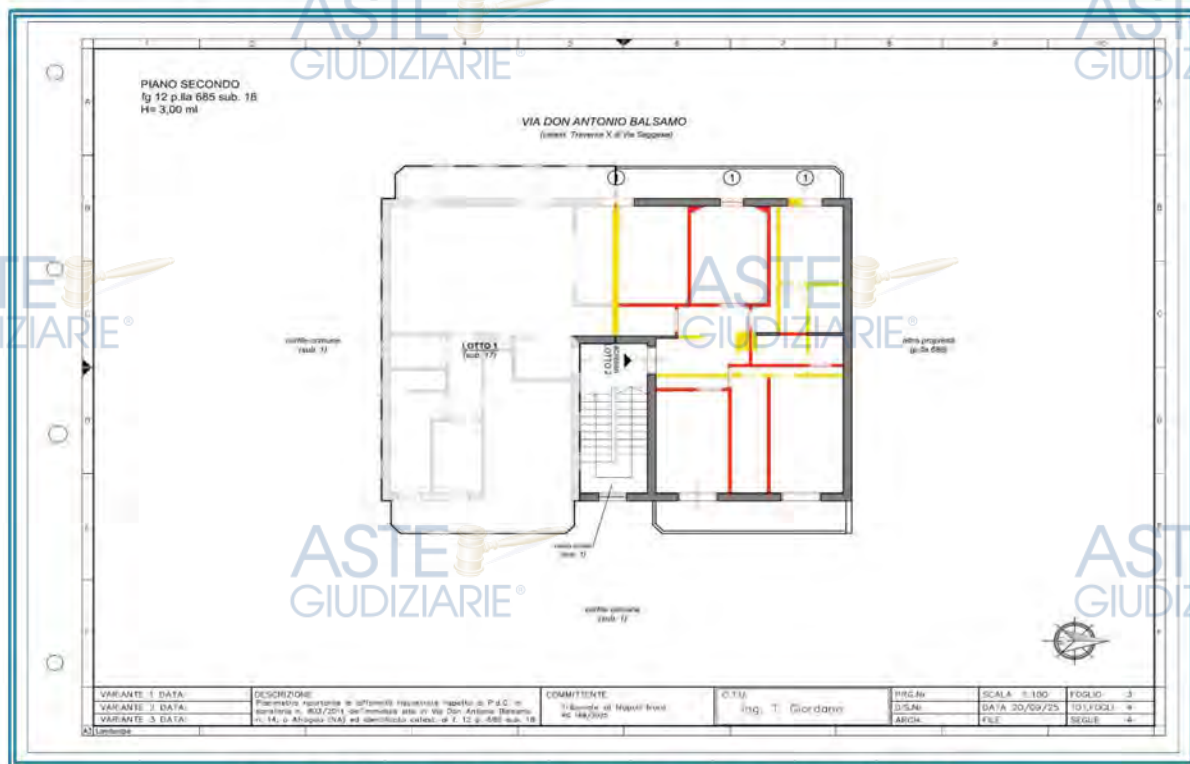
Schema diffinità urbanistiche - Piano Secondo (LOTTO 2)
